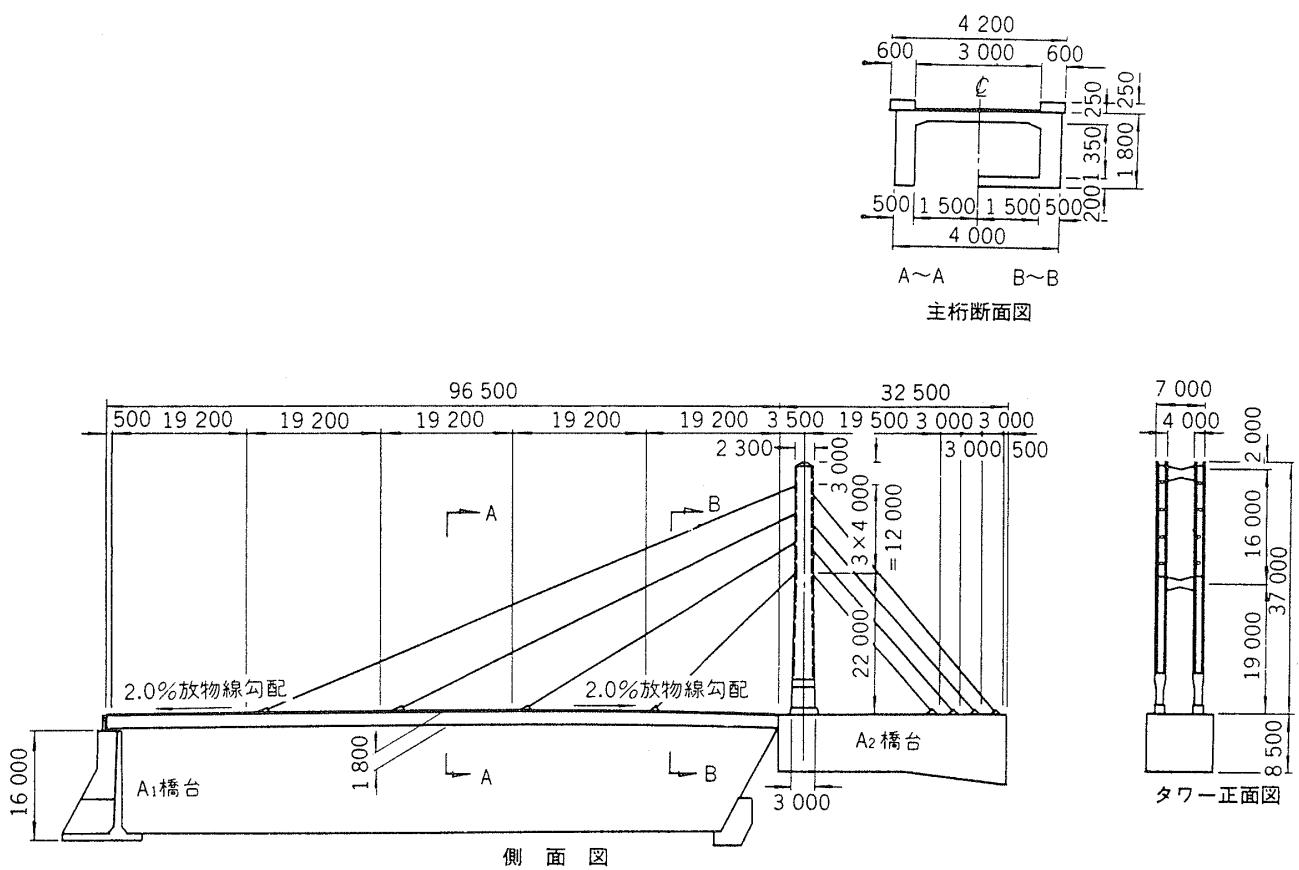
松ヶ山橋(神奈川県)⁴²⁾
